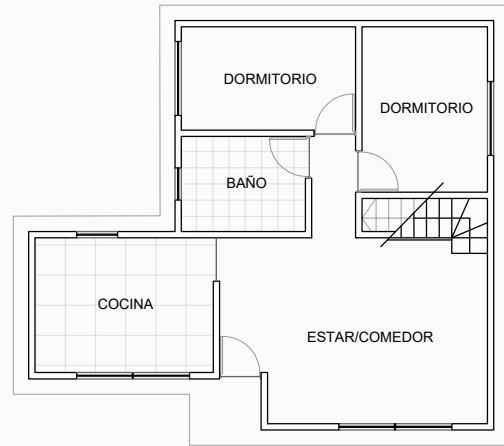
Planimetría vivienda original “Tipo A”. Fuente: elaboración propia en base a trabajo en terreno y entrevistas, 2018.
